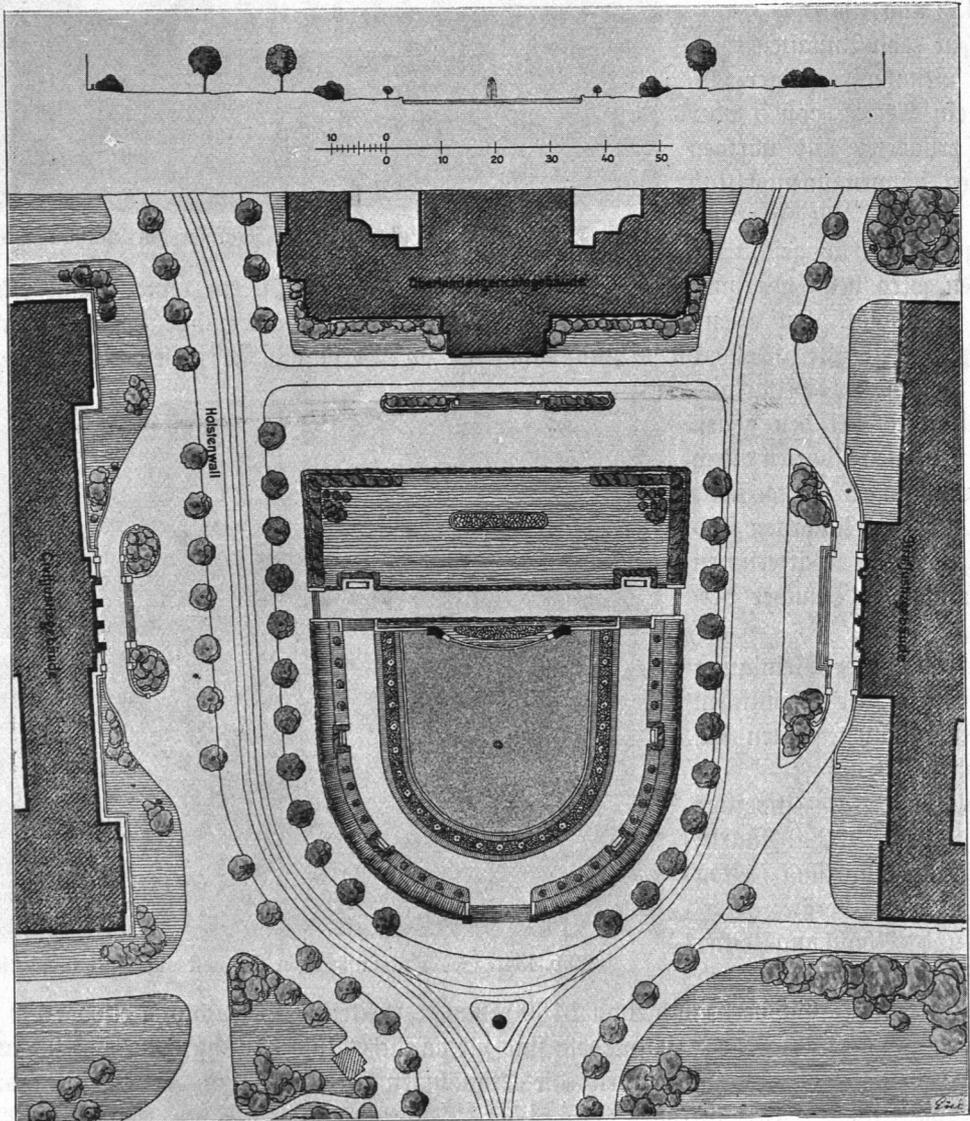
Grünanlage Sieveking-Platz, Lageplan.⁷
